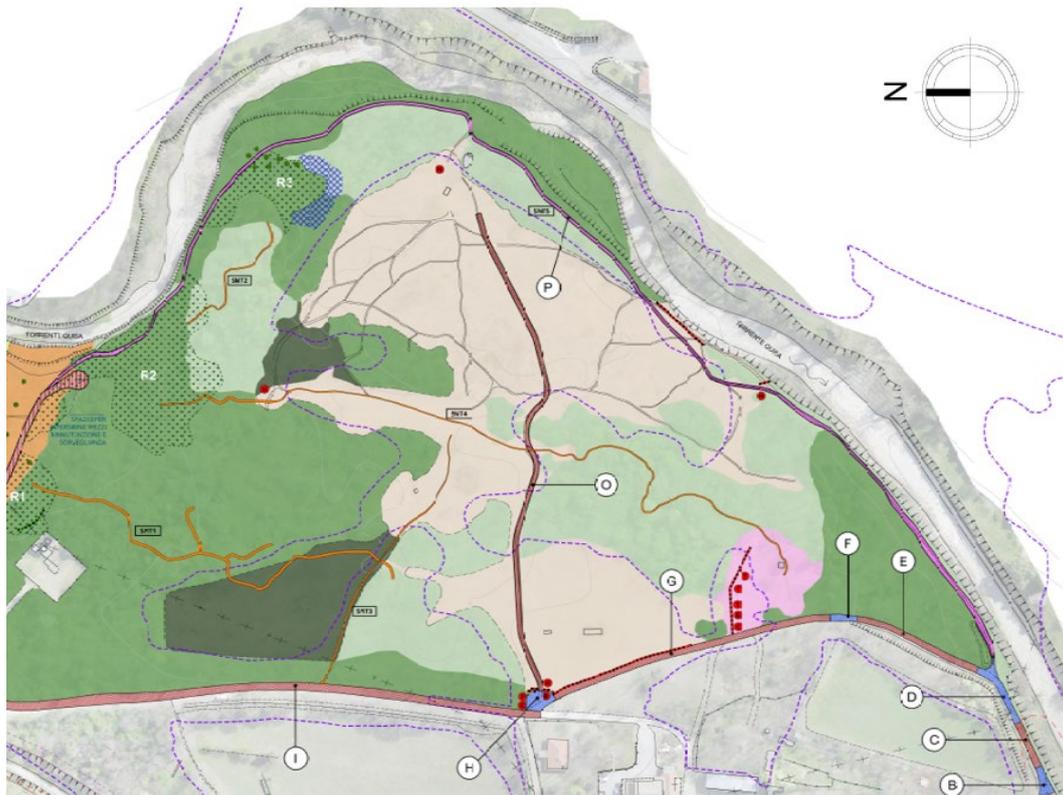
STRALCIO DELLA TAVOLA DI PROGETTO
